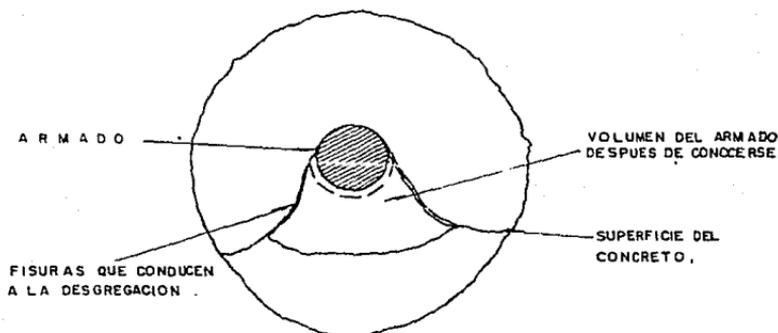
FISURAS EN EL CONCRETO DEBIDO A LA CORRÓSION DEL ARMADO.
